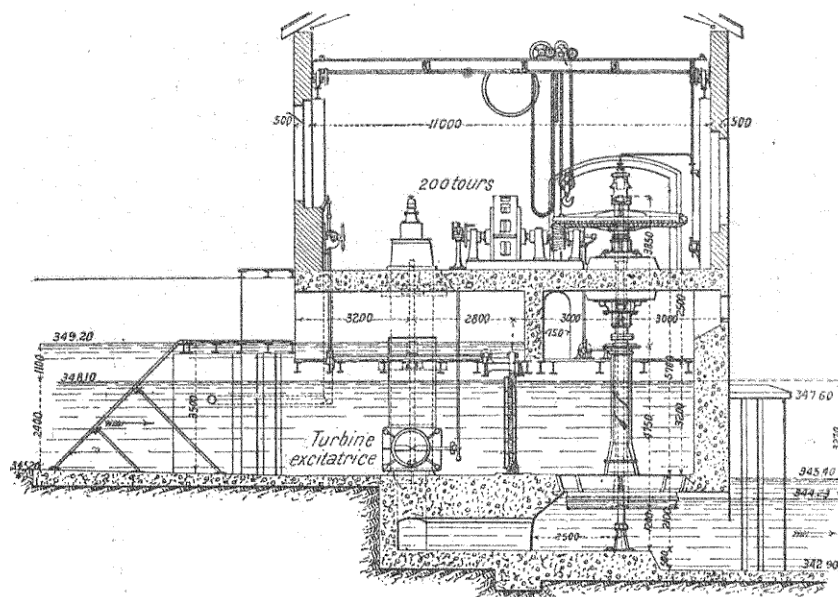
Installation d'une turbine parallèle pour chute de faible hauteur (Commande directe par engrenages).
